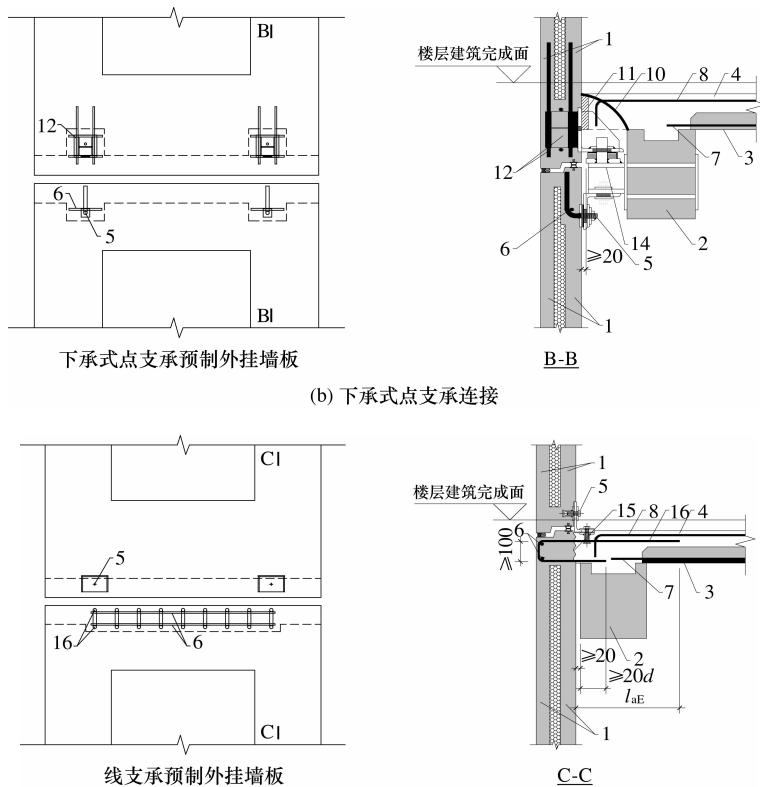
预制外挂墙体与主体结构柔性连接构造示意图
